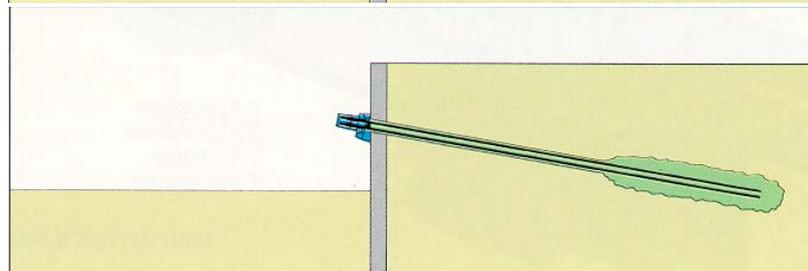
Arbeitsschritte Ankereinbau [2]
